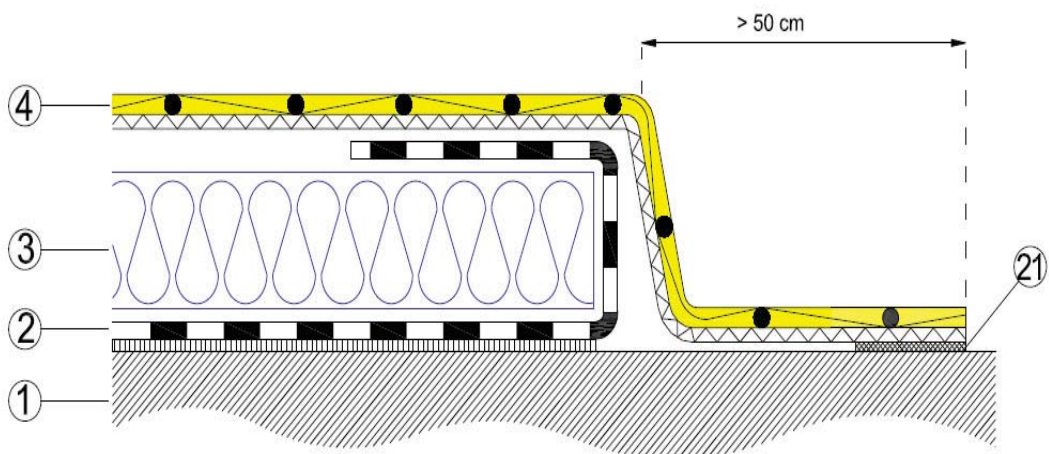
Fermeture provisoire de chantiers en travaux neufs
